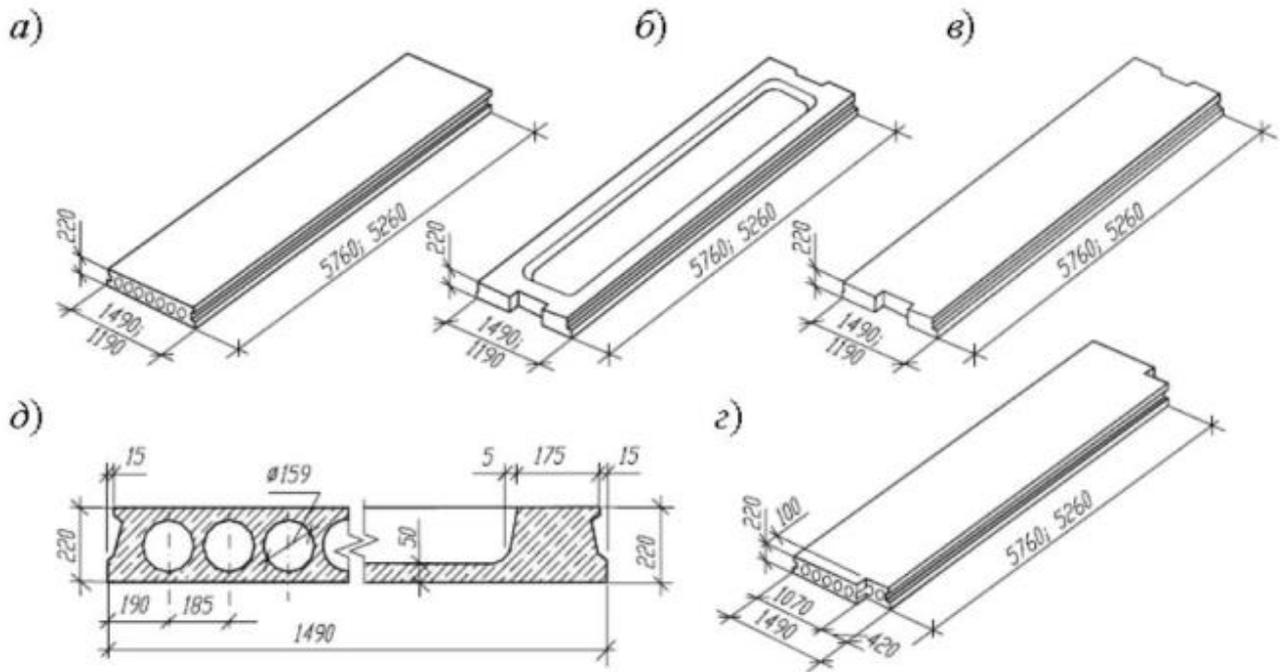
Плиты перекрытий каркаса 1.020
